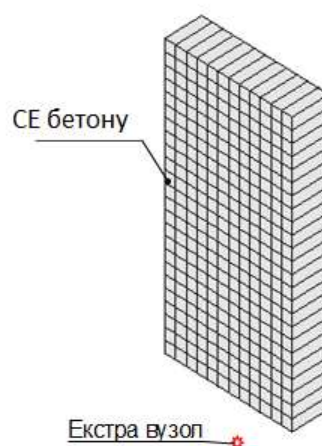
Скінченно-елементна схема залізобетонної балки для теплового розрахунку
